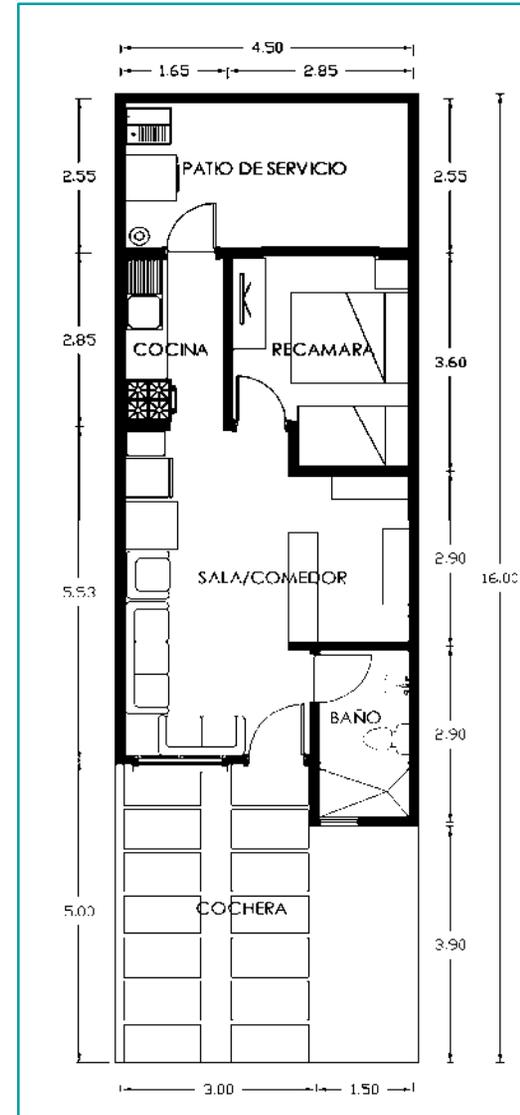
Planta de la vivienda con el mobiliario actual
